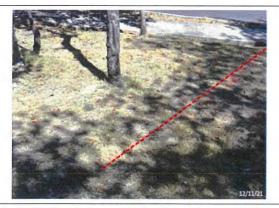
En rojo la proyección de los ejes de la calzada, ubicada en el camellón de Boulevard Adolfo López Mateos y Chivatito.
